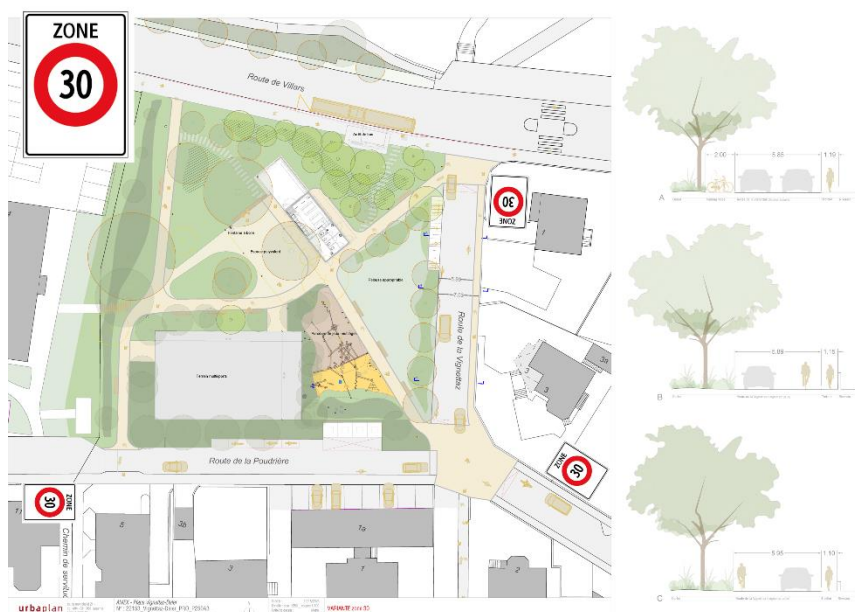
Plan d'aménagement avec la route de la Vignettaz en zone 30km/h
